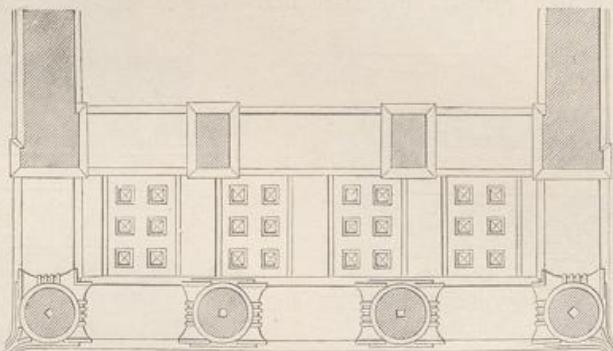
Niketempel zu Athen (Grundriss der Vorhalle, Decke).
